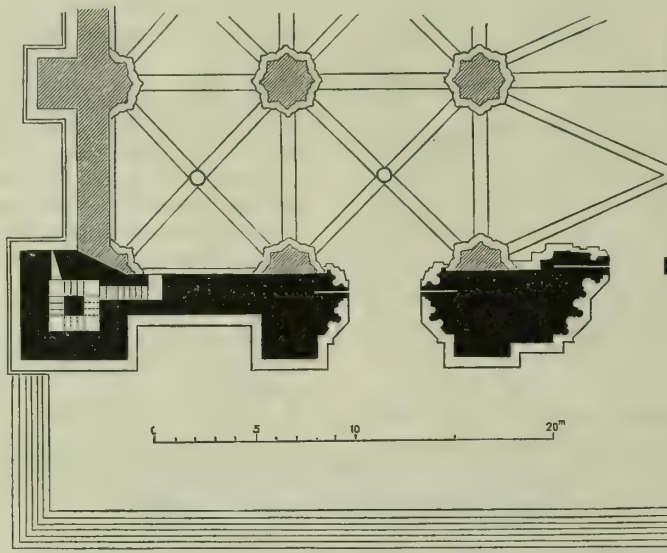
Grundriss in Erdgeschosshöhe.
